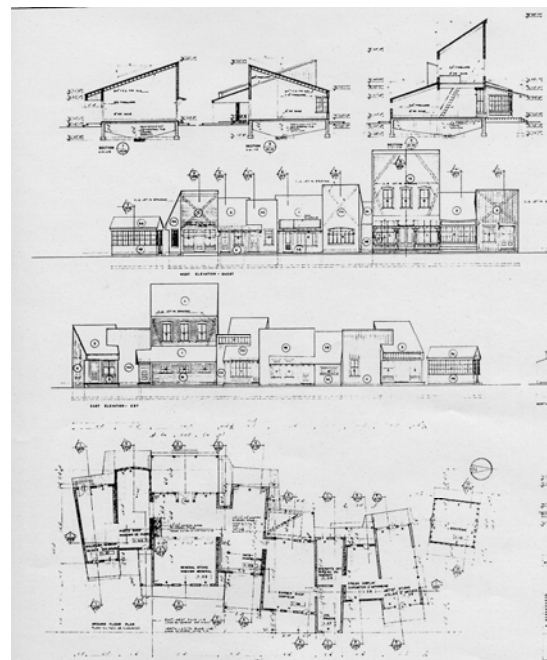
Élévations, plan et coupes des bâtiments centraux.
